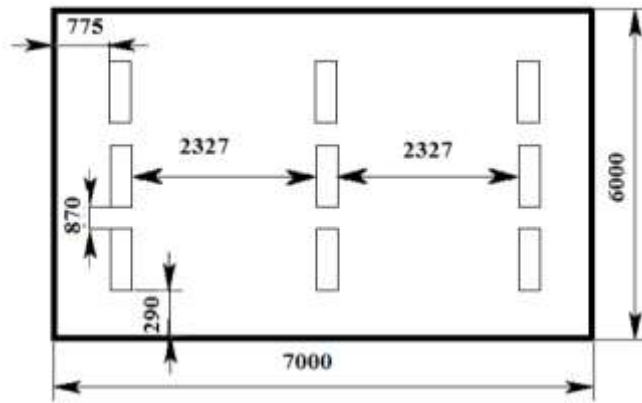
План помещения и размещения светильников с люминесцентными лампами.
